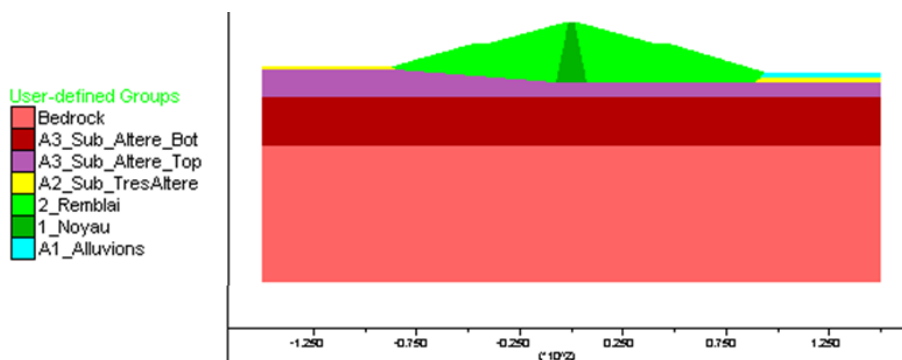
Matériaux constituant le barrage et sa fondation (nouvelle conception).
